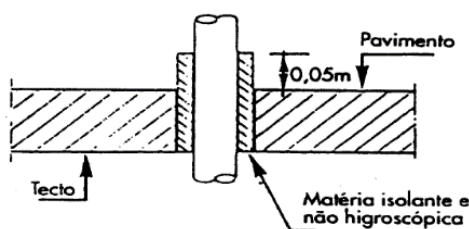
Instalação de tubagem de aço em atravessamentos (Portaria nº 361/98)
